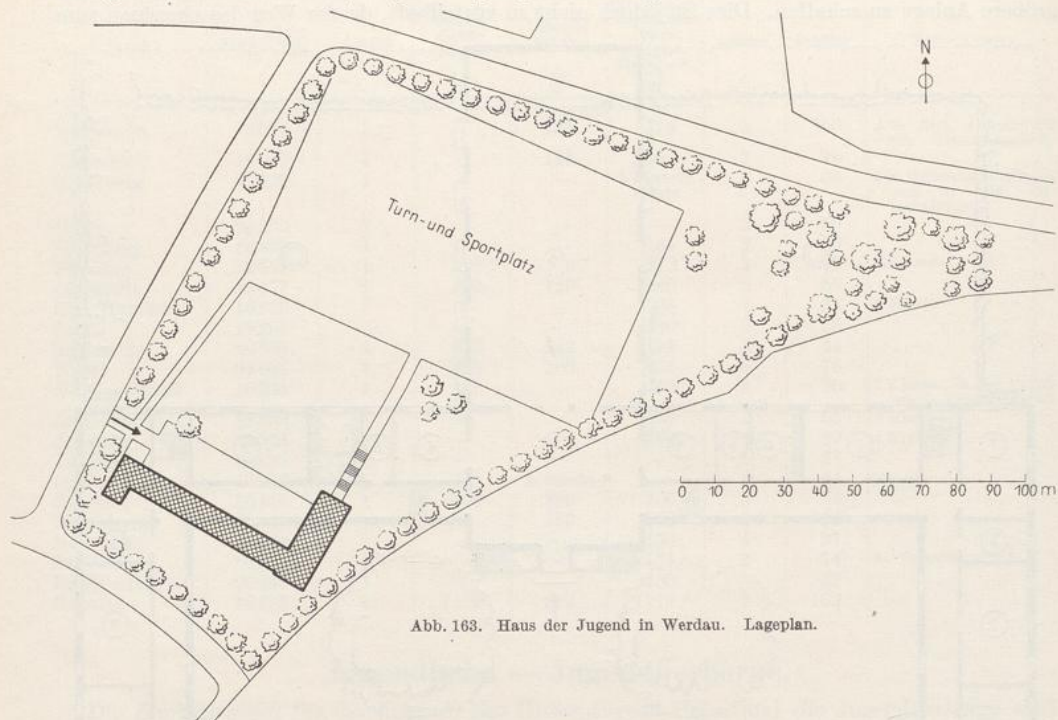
Haus der Jugend in Werdau. Lageplan.
